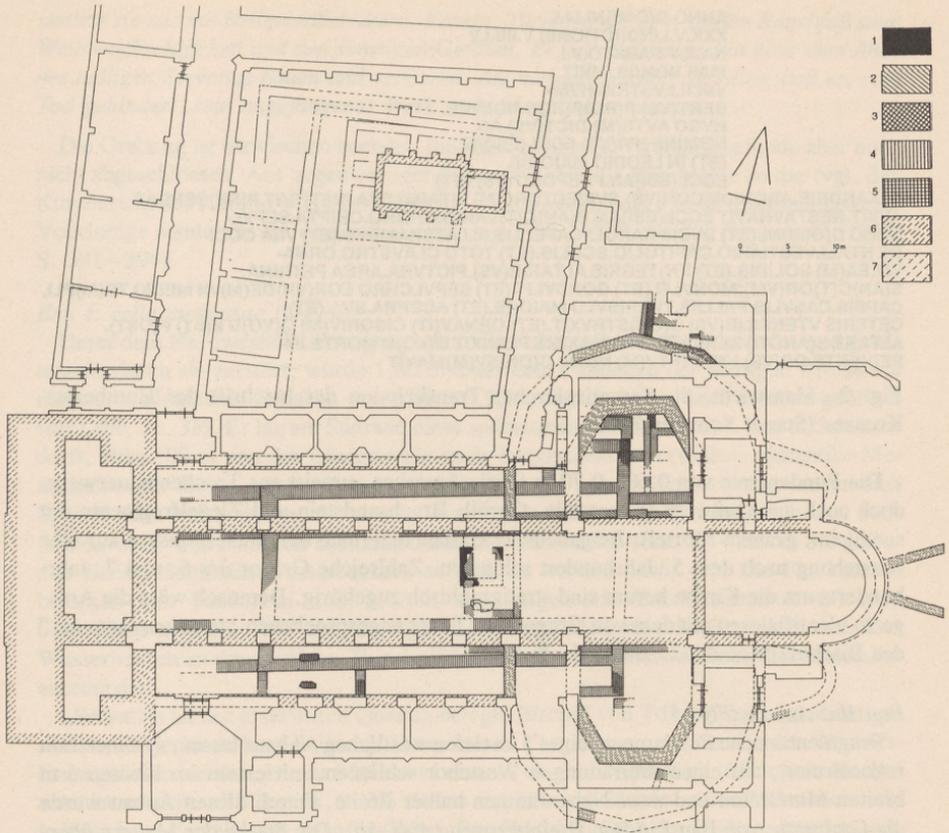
Maastricht, St. Servatiuskirche, Befundplan mit Eintragung aller Bauspuren.
